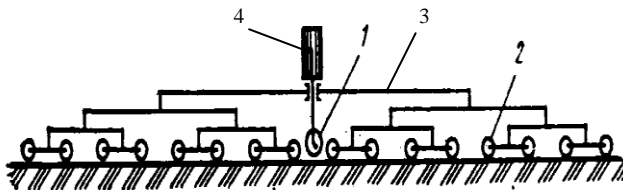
Схема многоколесного виографа: 1 – мерное колесо; 2 – колесо тележки для передвижения прибора; 3 – рама; 4 – регистрирующее устройство.
